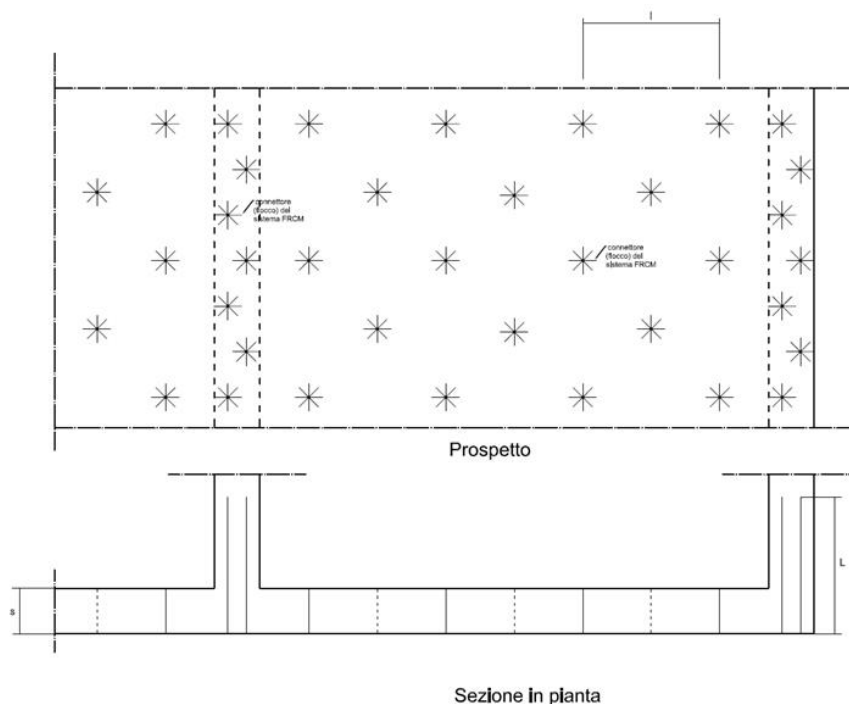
Intervento di rinforzo di parete in muratura con sistema FRCM e connettori (prospetto e pianta)
